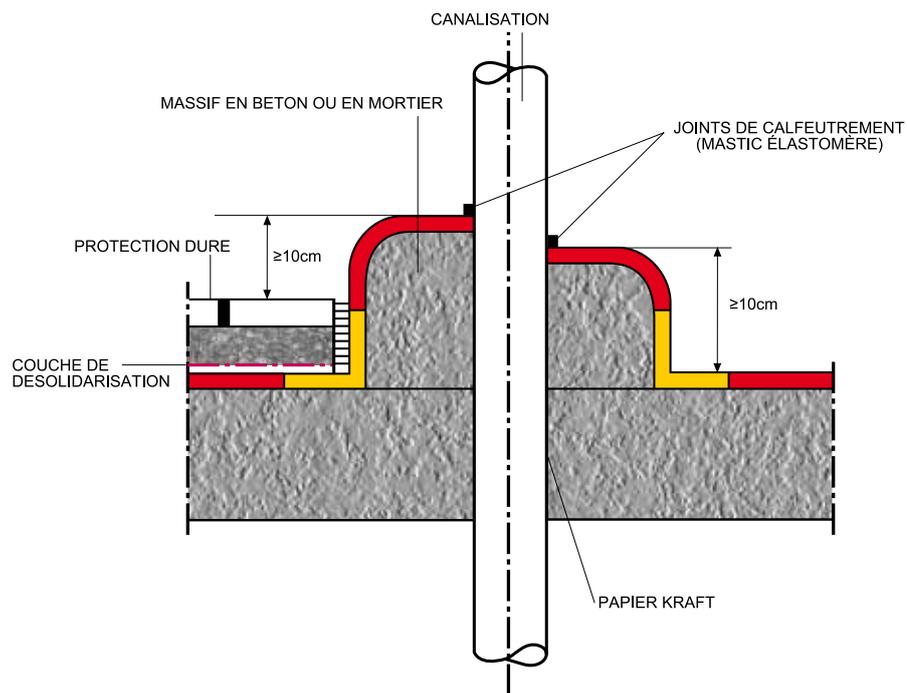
Traversée d'une canalisation existante sur massif sans fourreau
